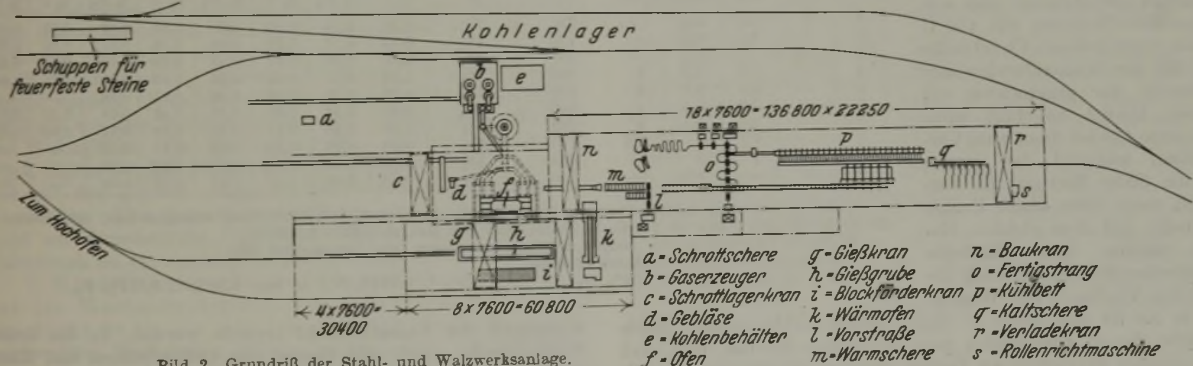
Grundriß der Stahl- und Walzwerksanlage.
